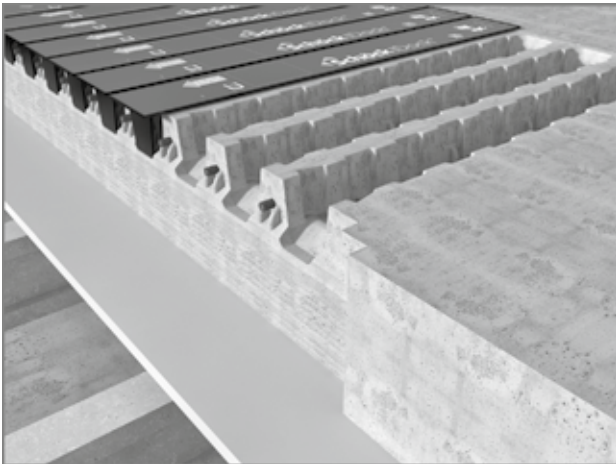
Schöck Isokorf® uitvoeringsvariant ID: Schöck IDock® voor het gieten van de betonvloer
